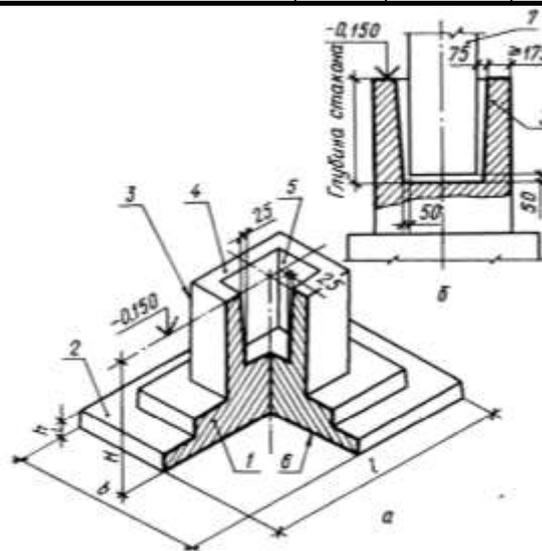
Монолитный железобетонный столбчатый фундамент:
